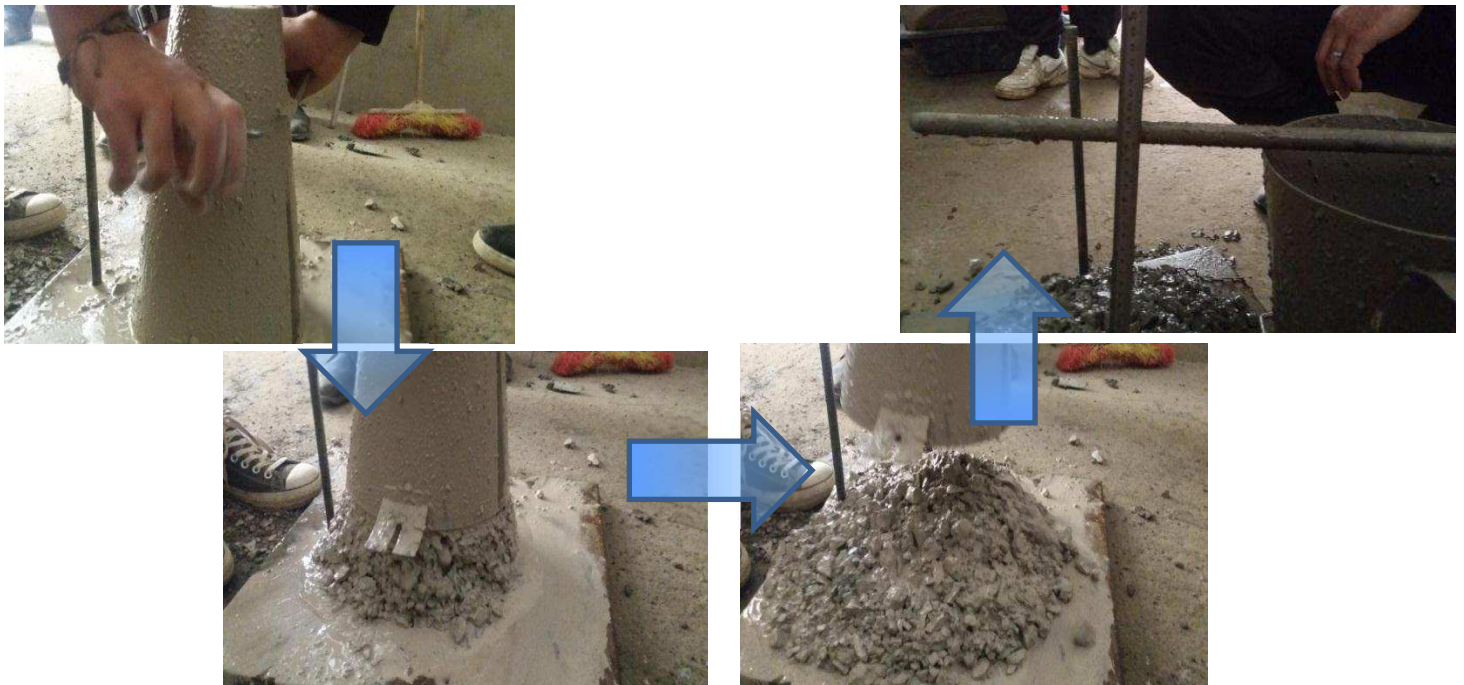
Conduite de l'essai d'affaissement (NF P 18-451)
